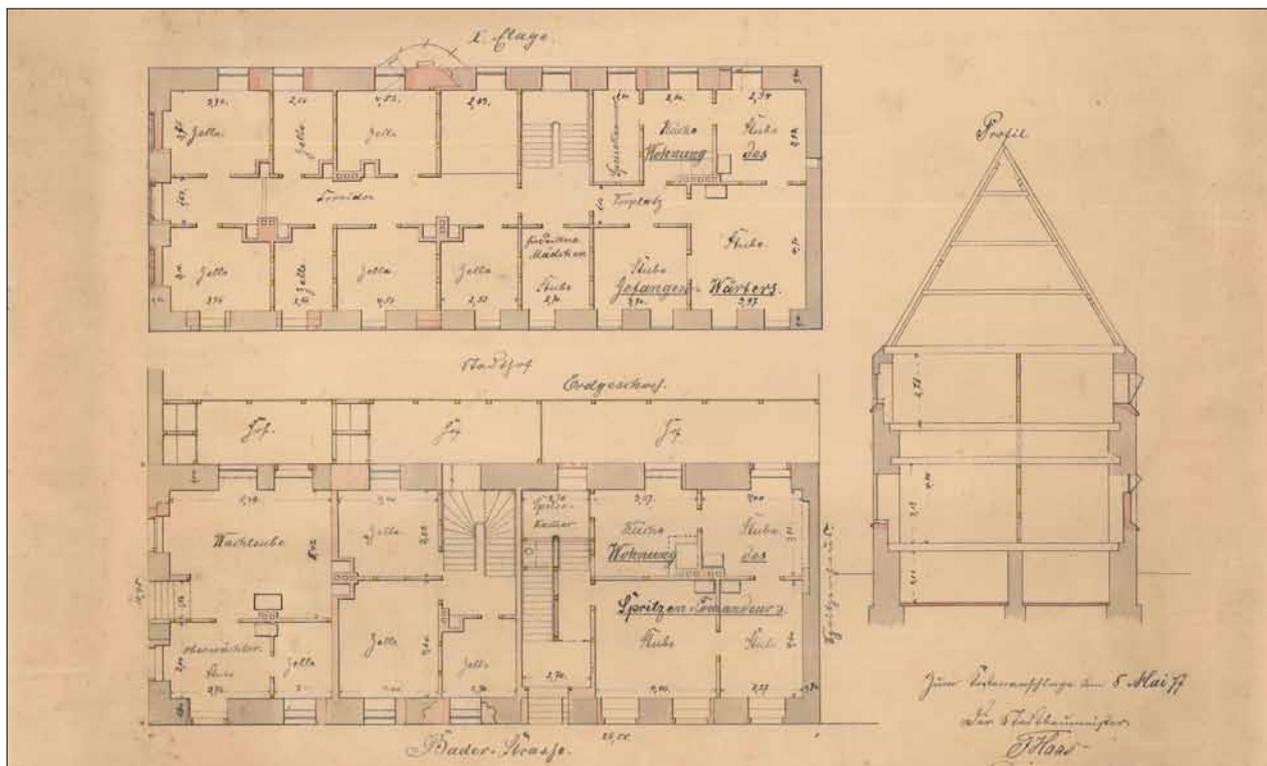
Greifswald, Baderstraße 24. Planungszeichnung vom Mai 1877 für einen Umbau des „Syndikatsgebäudes“ zum Polizeigefängnis. Links sind (von unten nach oben) die Grundrisse des Erd- und des Obergeschosses mit den rot eingetragenen Hinzufügungen dargestellt. Im nördlichen Bereich (links) sollte die eigentliche Haftanstalt eingerichtet werden. Auf der Südseite (rechts) waren Wohnungen geplant, im Obergeschoss die des ›Gefangenwärters‹, im Erdgeschoss die des ›Spritzen-Commandeurs‹ der südlich benachbarten Feuerwehr. Abbildung: STAG Pläne C 1723 (Ausschnitt)
